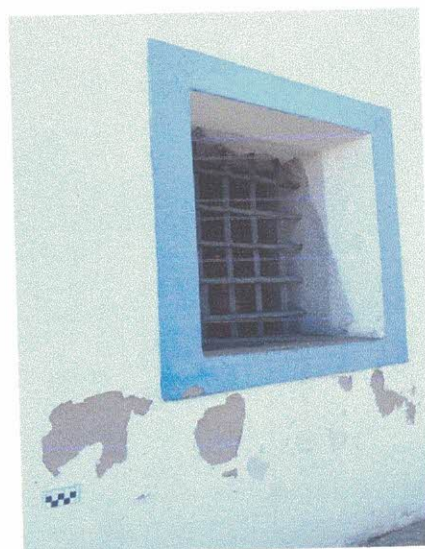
Desgaste da alvenaria próximo a Janela externa, pavimento térreo.
